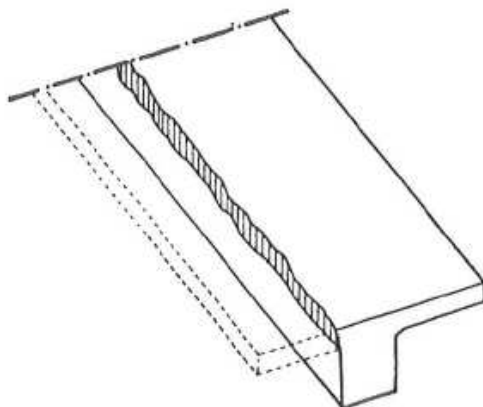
Falta de cosido en ala de viga (Robinson)
